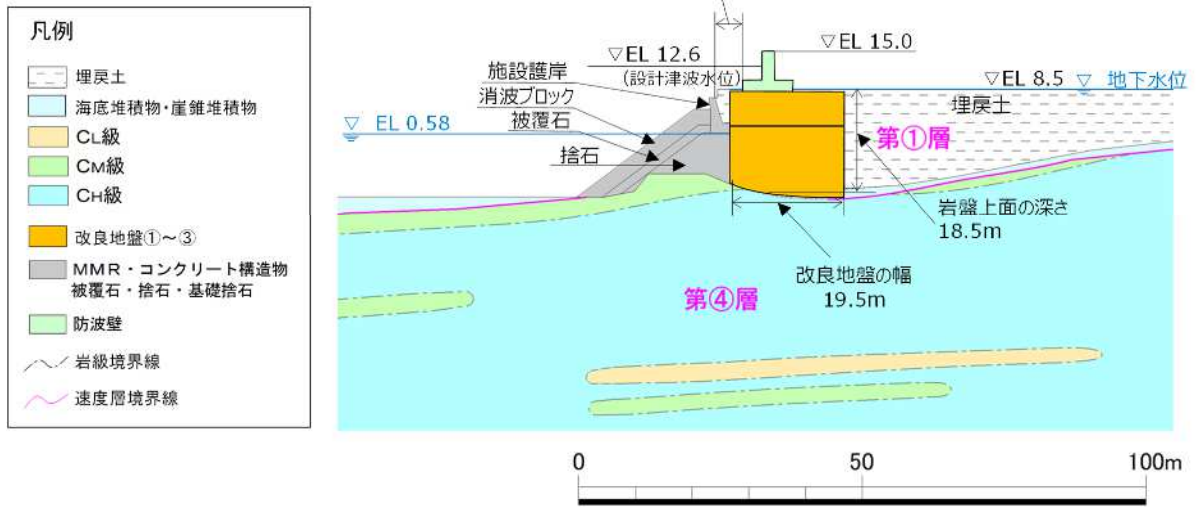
防波壁（逆 T 擁壁）の横断面図（⑤-⑤断面）
